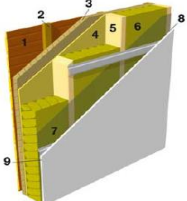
Exemple de joint de mousse comprimée en pied de doublage ou entre lisses pour empêcher l'air de s'infiltrer aux liaisons plancher/panneaux de façade
